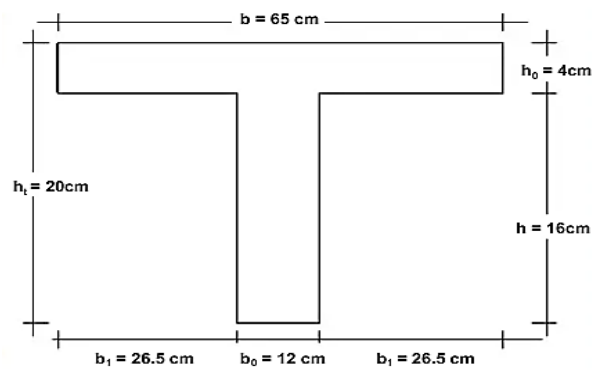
Section considérée pour le calcul du ferrailage. "SOCOTEC"
